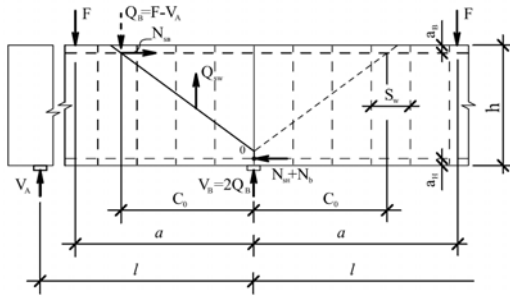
Розрахункова схема зусиль у похилому перерізі приопорної ділянки нерозрізної залізобетонної балки.
